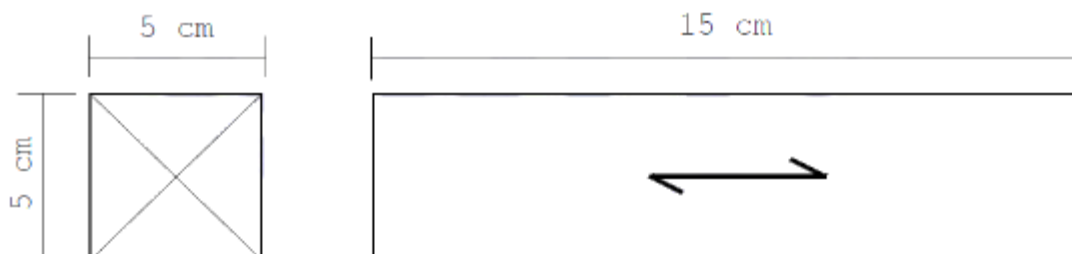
Corpo de prova para ensaio de compressão paralela às fibras.
